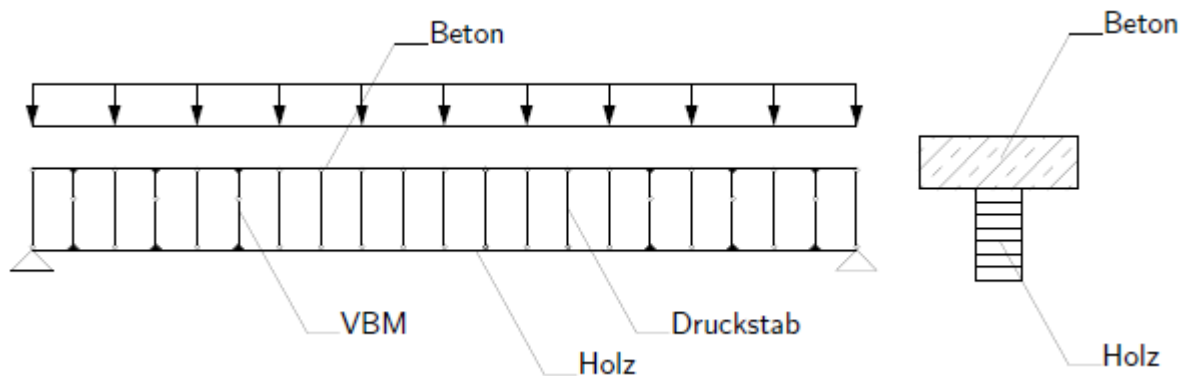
Modellierung einer Holz-Beton-Verbunddecke mithilfe eines Stabwerkmodells [8]
